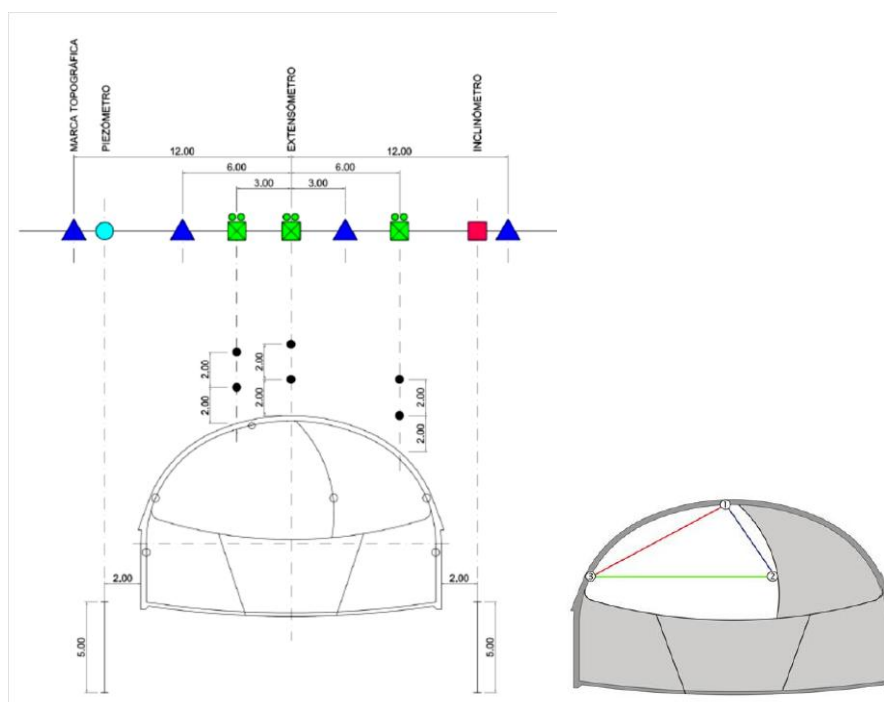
Secção tipo de instrumentação e secção de convergências da 1.ª fase de escavação (Coba, 2009)
